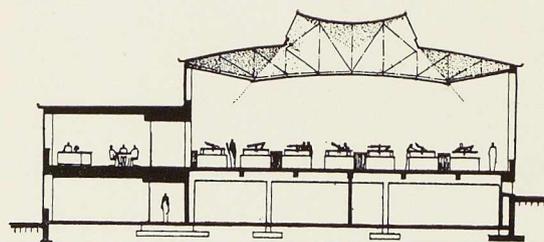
(ci-dessus). Coupe transversale dans le bâtiment du bureau de dessin.
